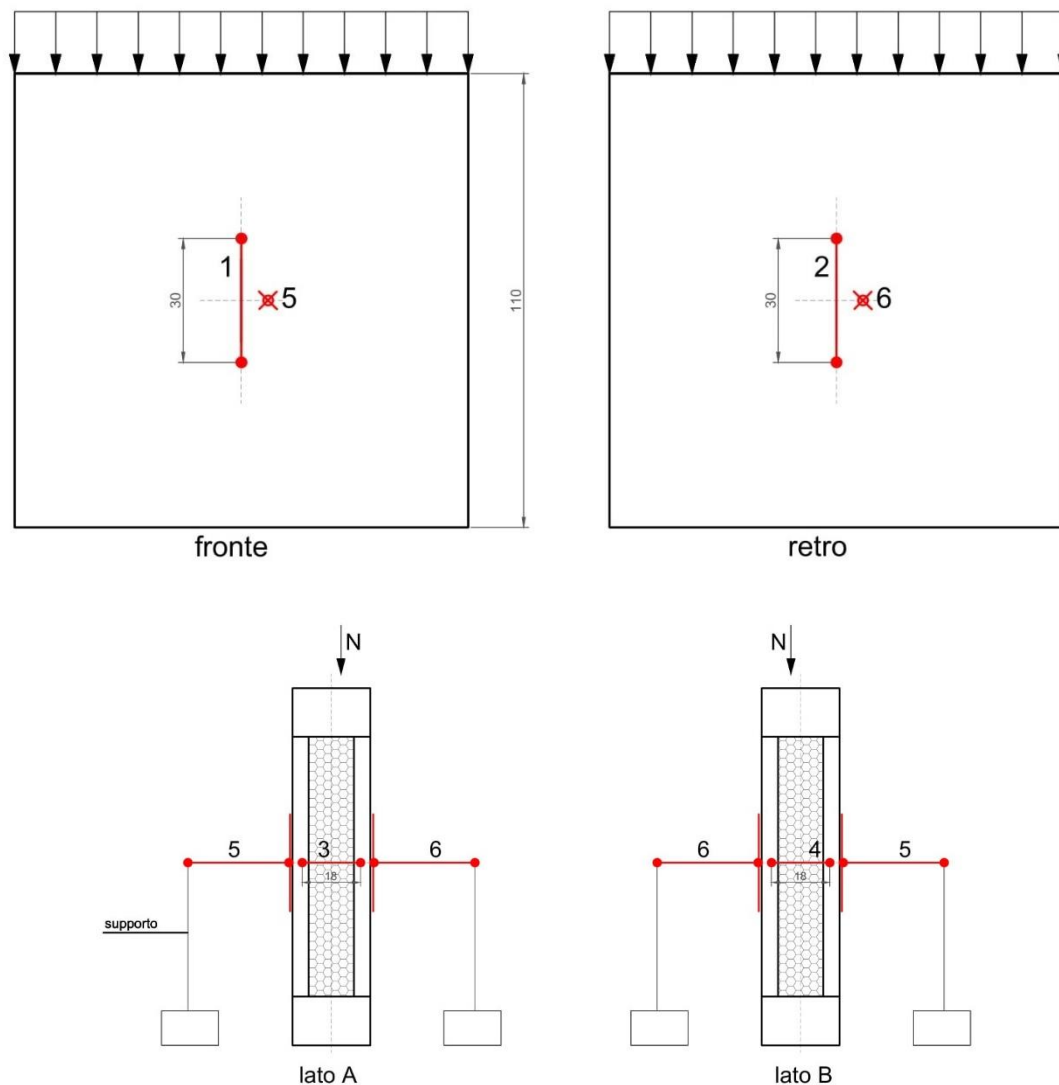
Disposizione dei trasduttori sulle facce fronte e retro, lato A e lato B del provino
